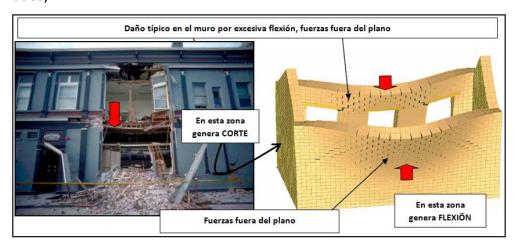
Daño típico en el muro por excesiva flexión, fuerzas fuera del plano
